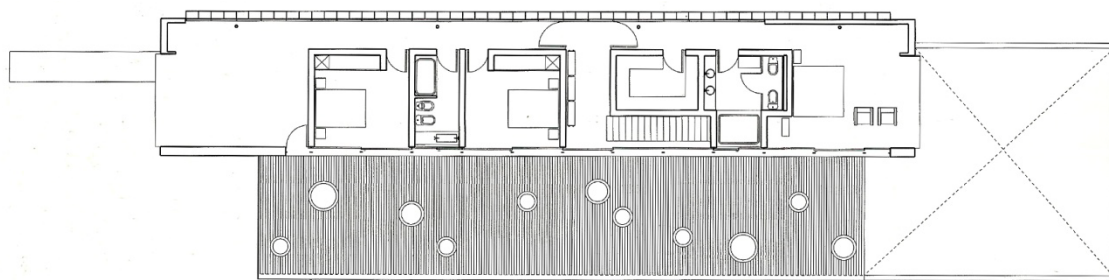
Planta segunda. 2G Revista Internacional de Arquitectura
